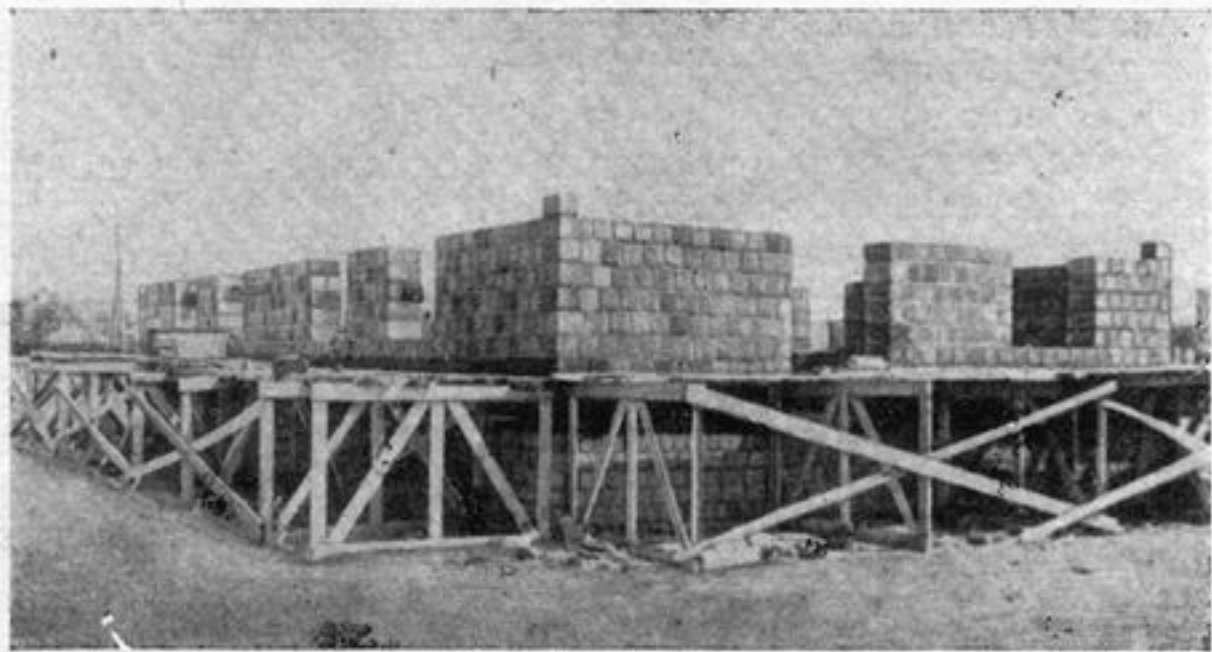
Строительство жилого дома из грунтосиликатных блоков.
